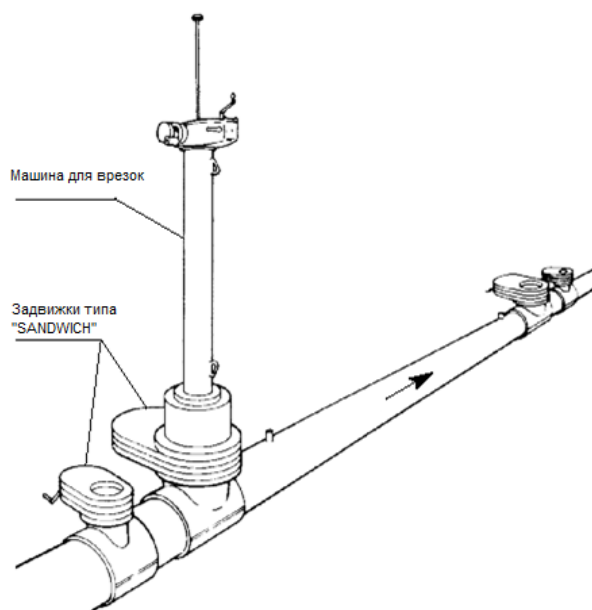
Установка задвижек и машины для сверления отверстий
